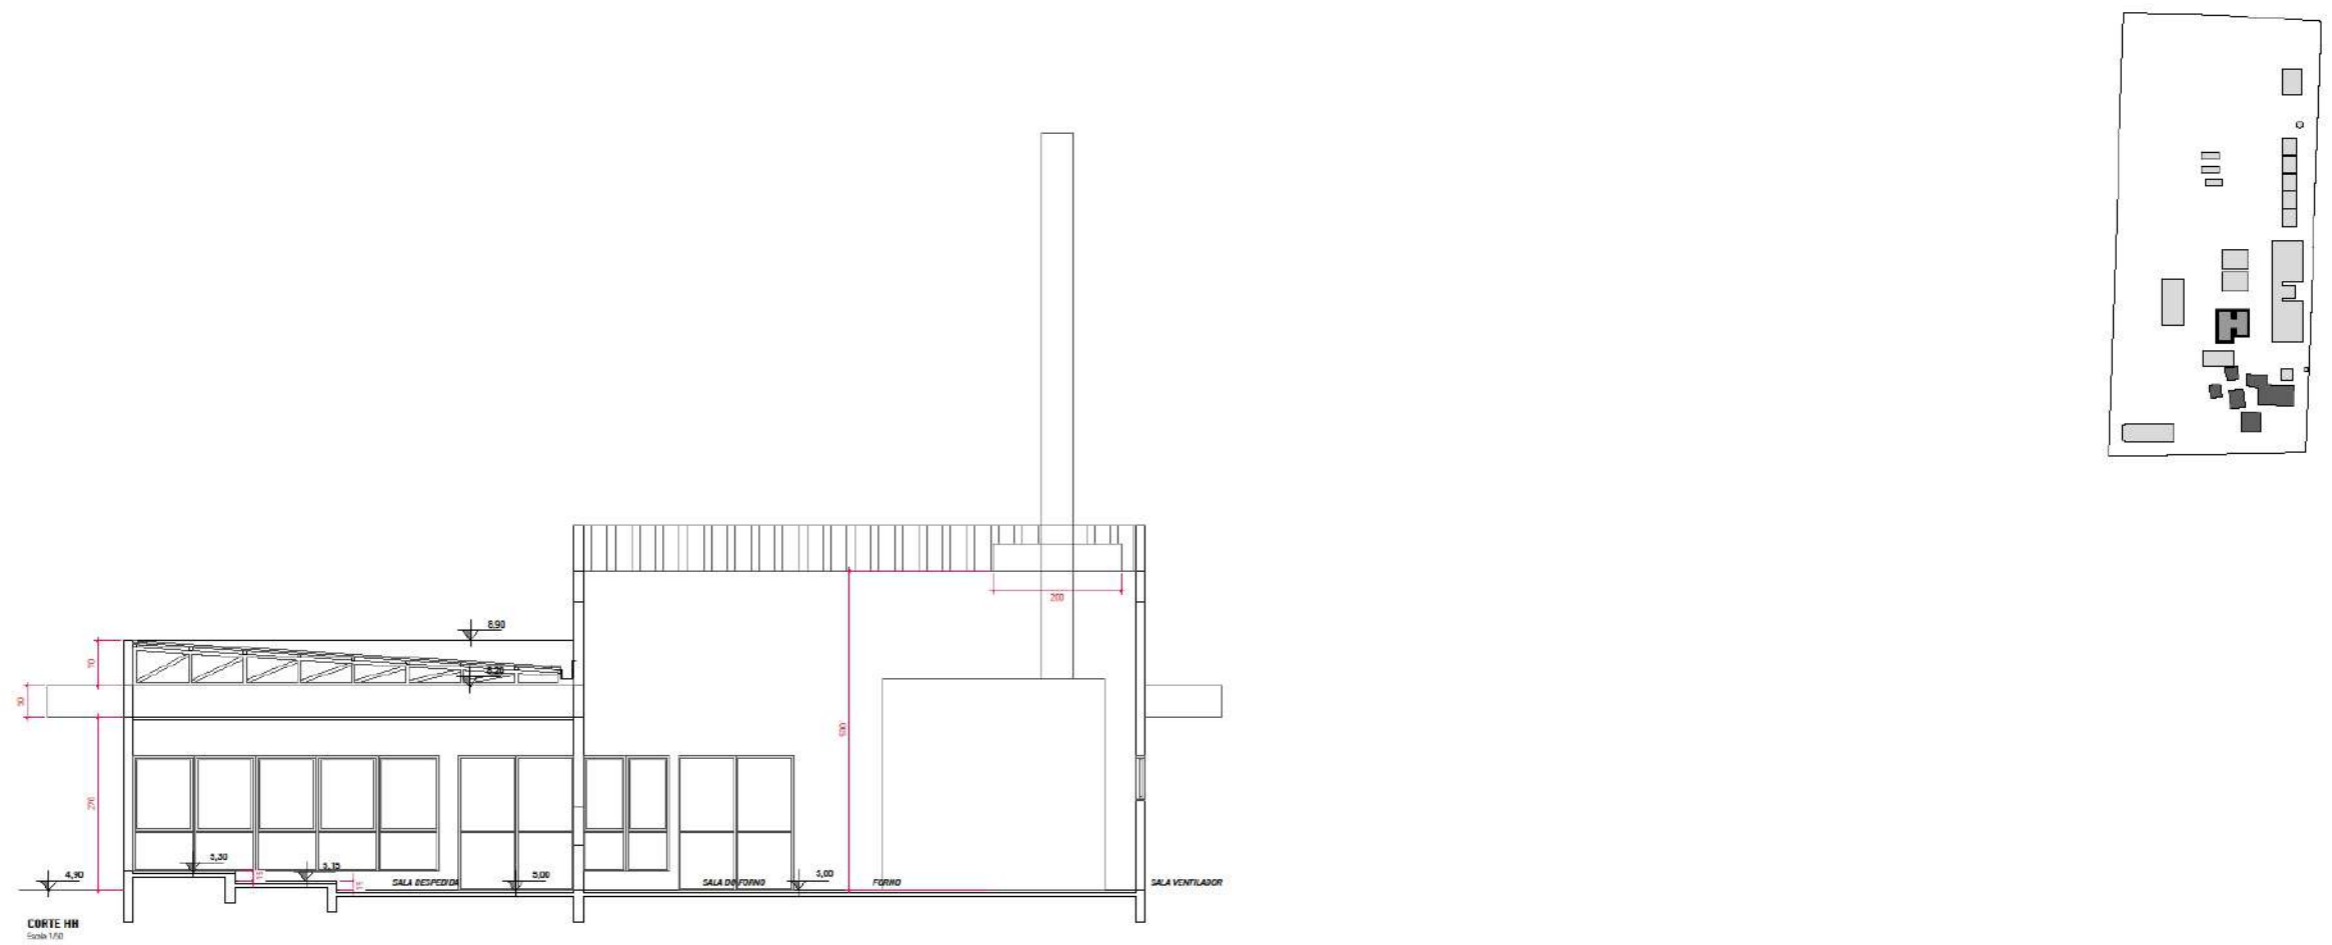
Projeto Arquitetônico – Prancha 14-24.
